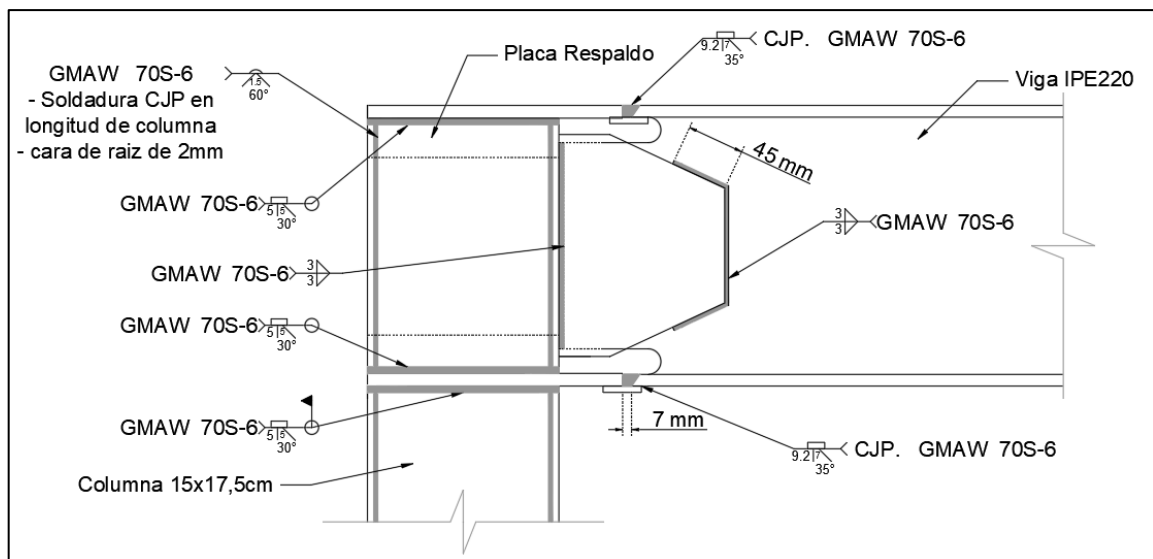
Vista lateral de detalles de soldadura en la conexión Viga-Columna.
